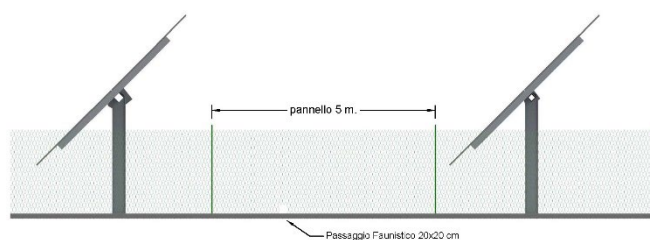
Prospetto recinzione perimetrale senza mitigazione
